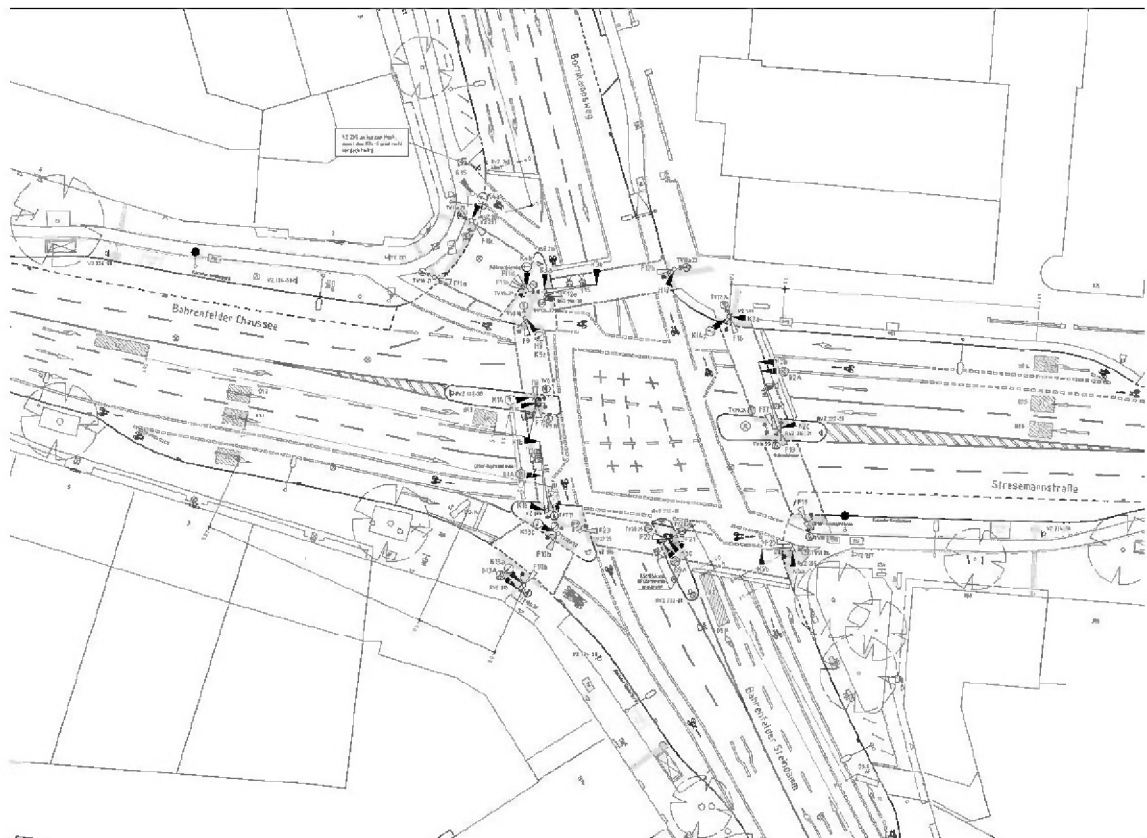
Signallageplan Bahrenfelder Chaussee/Bornkampsweg – Bestand (15/353-04-08/06)
